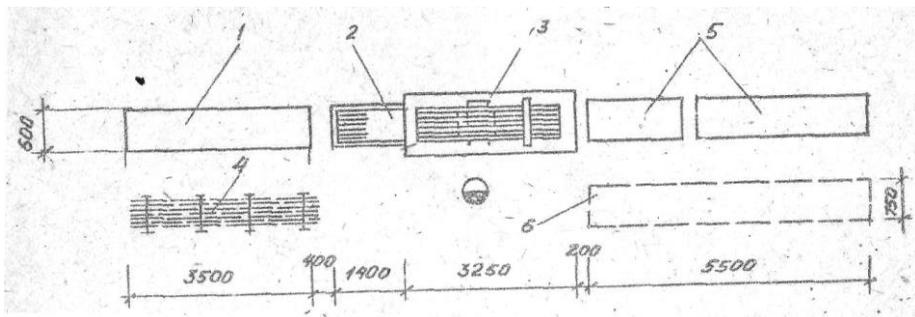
Схема технологической линии для сварки плоских каркасов:
